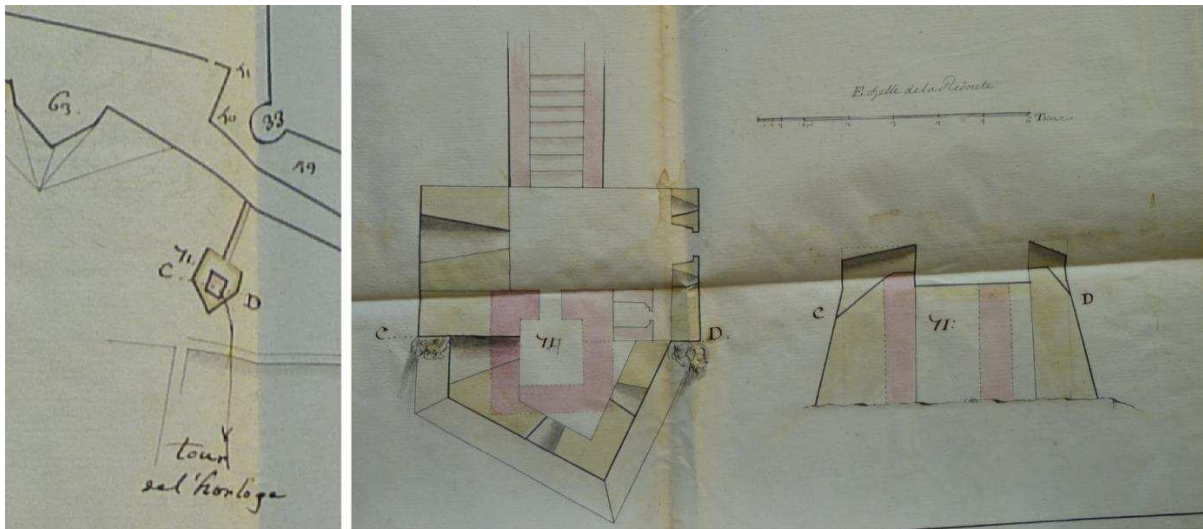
Projet d'une redoute envisagée par La Berrie sur les ruines de la tour de l'horloge de la Ville, tracé en plan et en profil (cl. E. Guilloteau).
